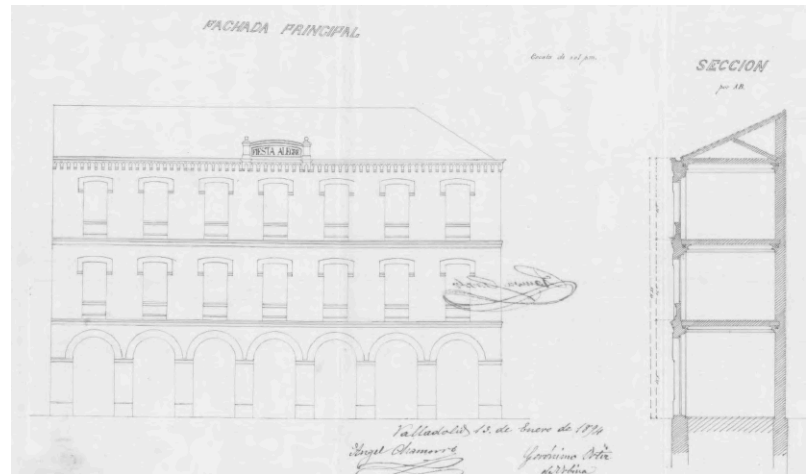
Fachada y sección. Jerónimo Ortiz de Urbina. 1894.
